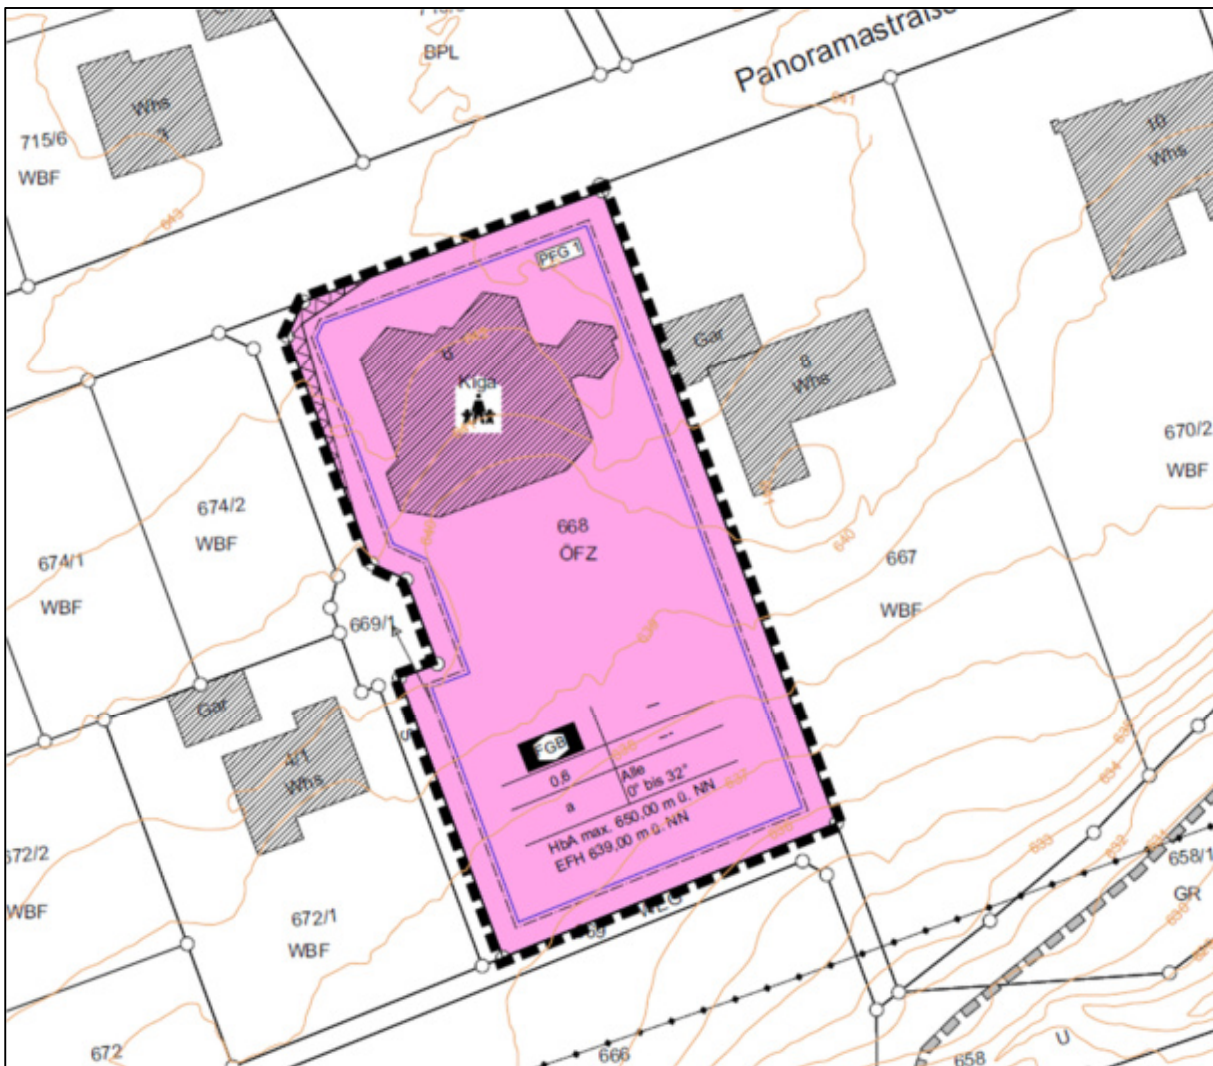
Lageplan, unmaßstäblich (schwarze Balkenlinie)
